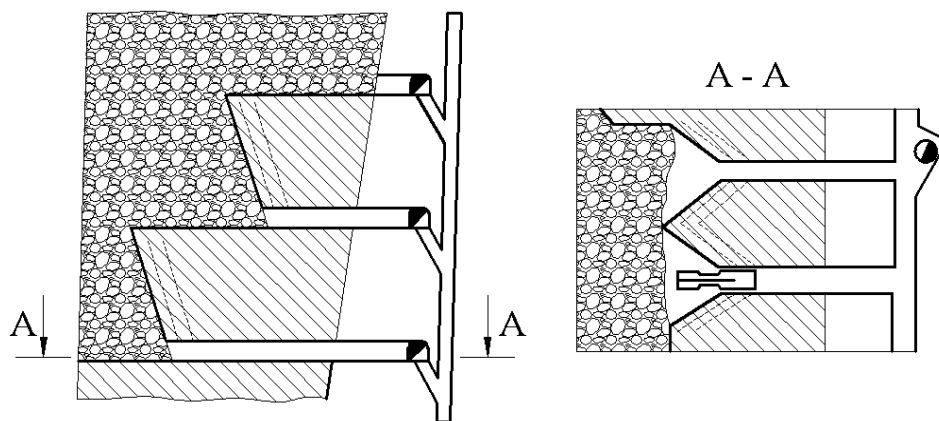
Подэтажное обрушение с треугольной подсечкой.
